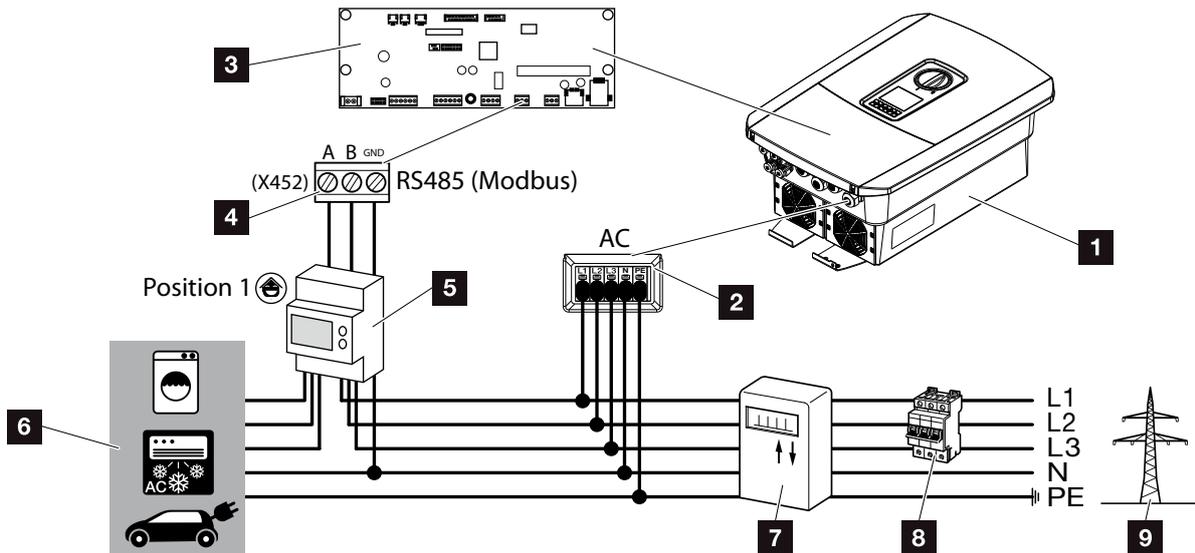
Schema di connessione contatore di energia – Collegamento lato rete domestica (posizione 1)
